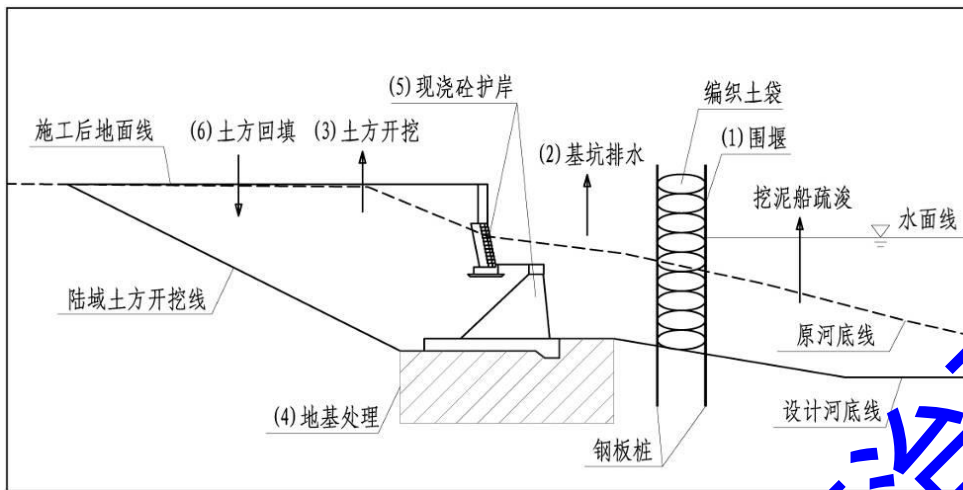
现有河道拓宽段护岸施工示意图（图中序号表示施工顺序）
